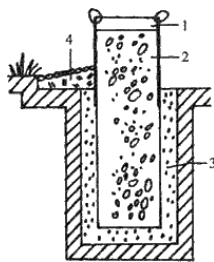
Столбчатый фундамент в скользящей опалубке: 1 – скользящая опалубка; 2 – бетон; 3 – песчаная засыпка; 4 – отмостка.
